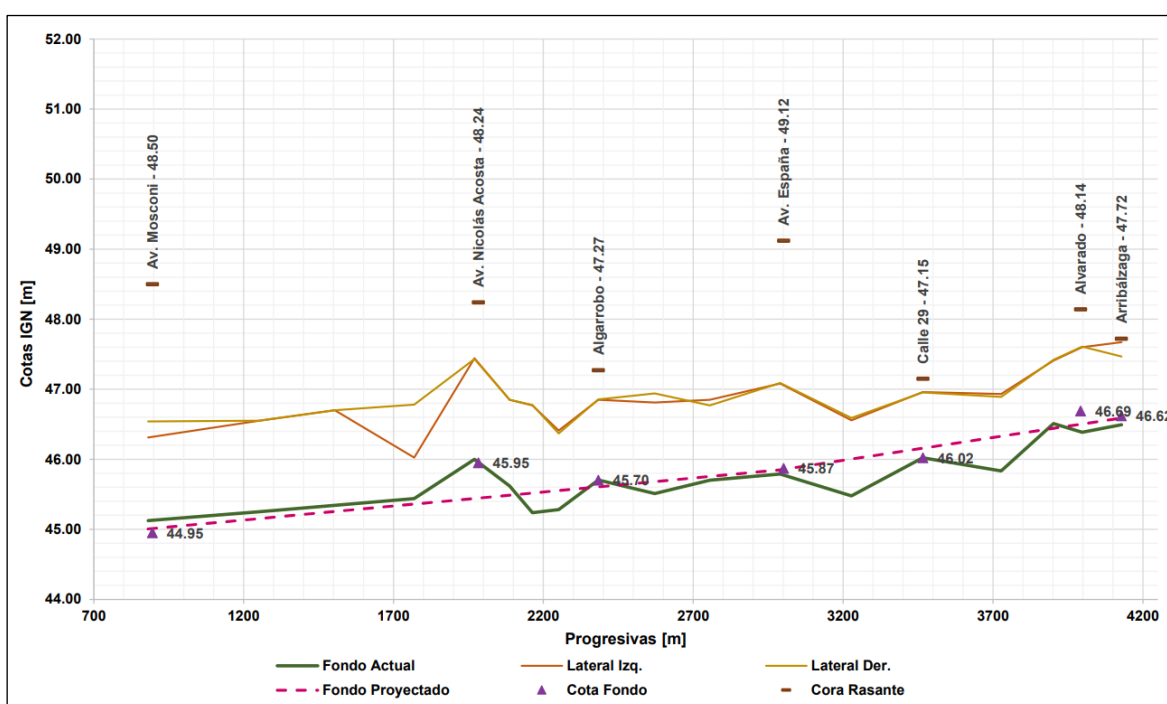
Perfil longitudinal actual y con fondo proyectado. (Fuente: Elaboración propia).
